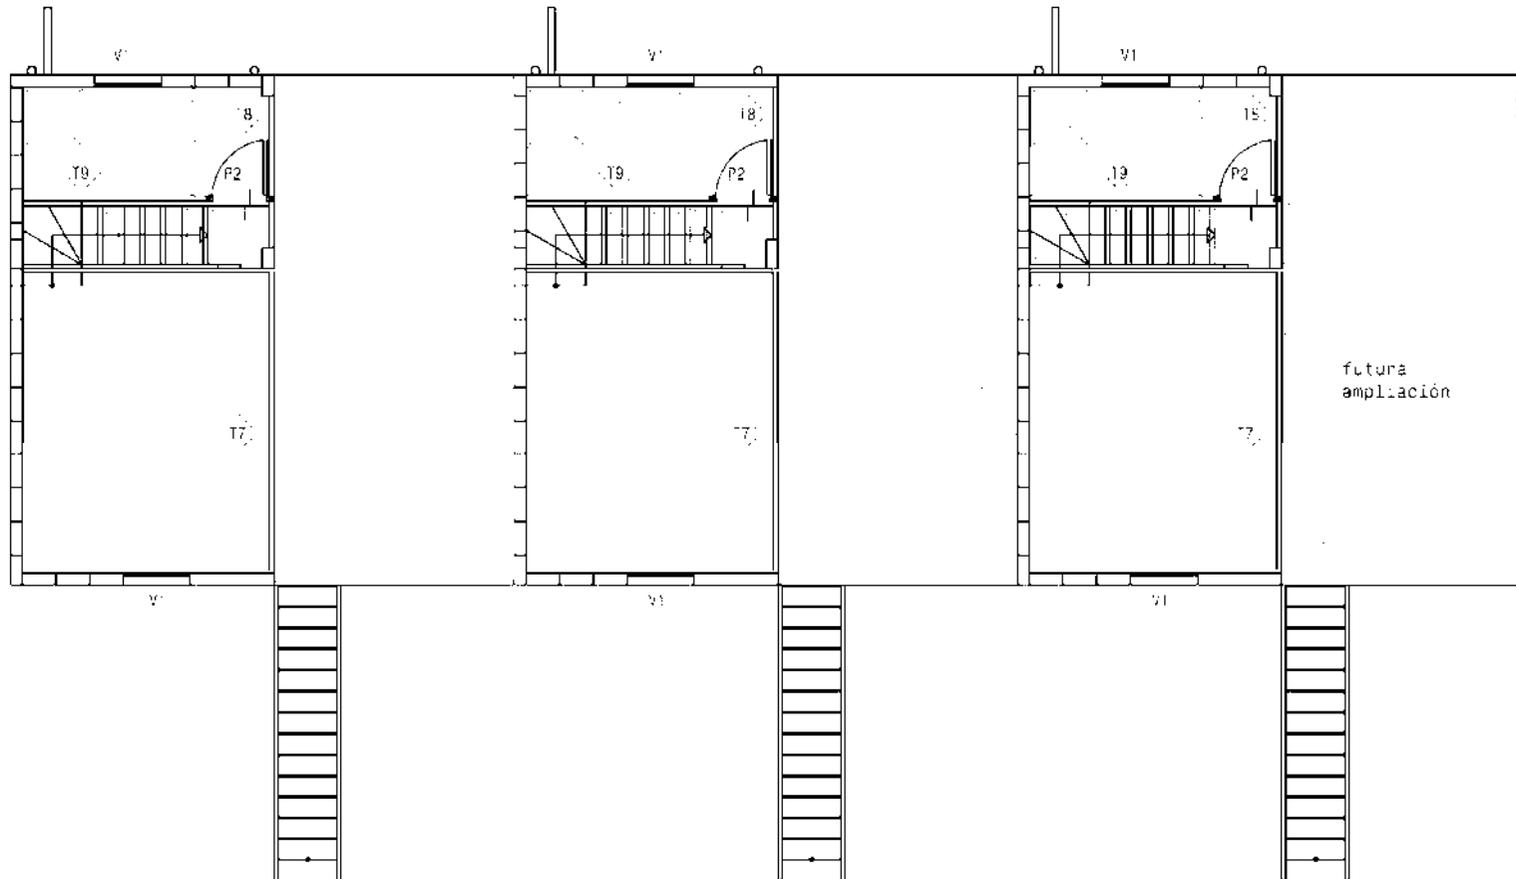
Planta arquitectónica del segundo nivel, Quinta Monroy, Iquique, Chile, Alejandro Aravena
